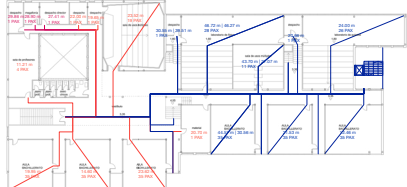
Recorridos evacuación propuestos. Planta primera pabellón D.
